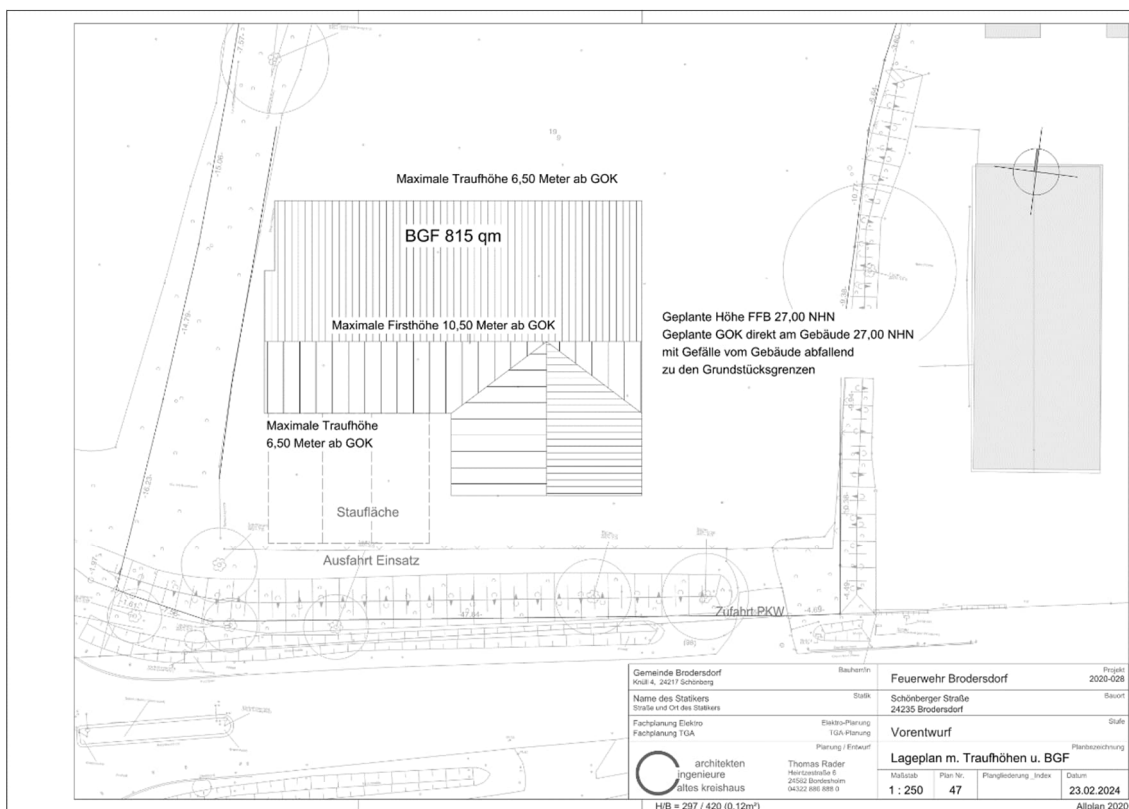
Objektplanung, Stand: 23.02.2024
